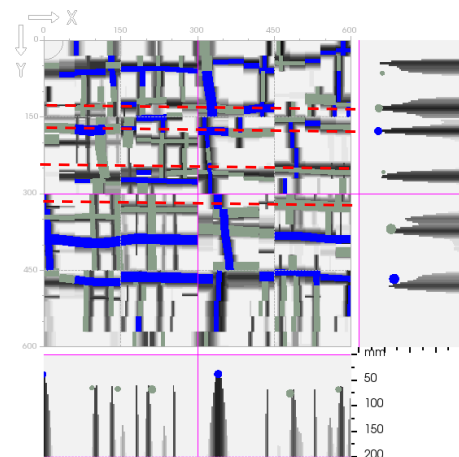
Poutre Pt03 – Travée 4 à mi-travée
